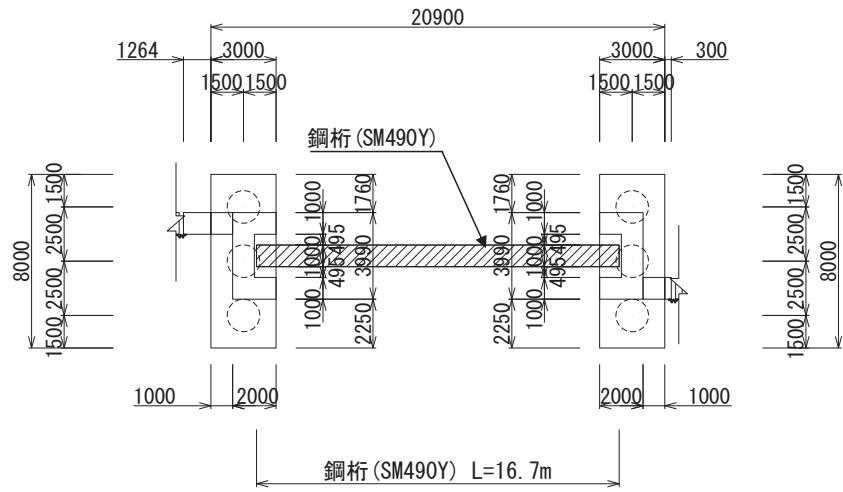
(2) 鋼製遮水壁 (鋼桁 2) 平面圖
